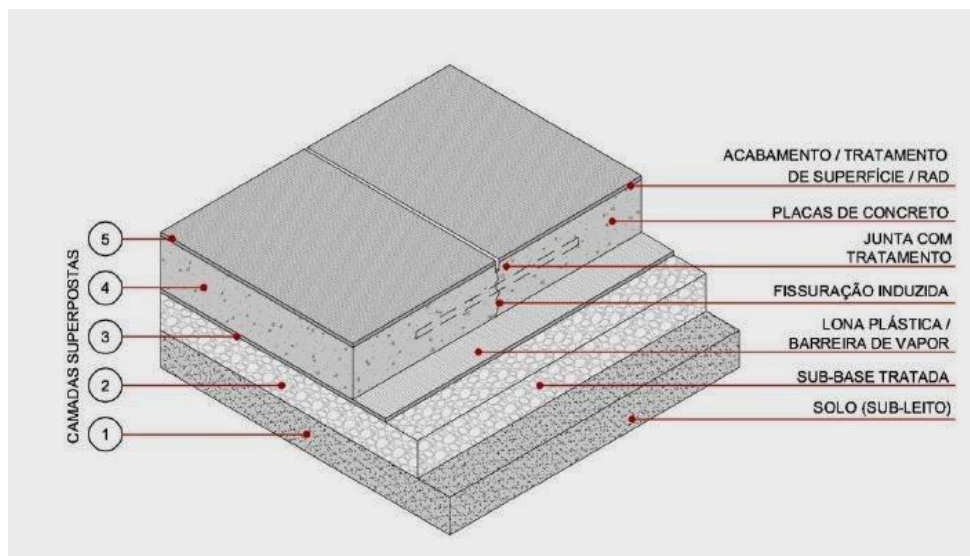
Sistema construtivo de um pavimento industrial [adaptado de ⁵].
